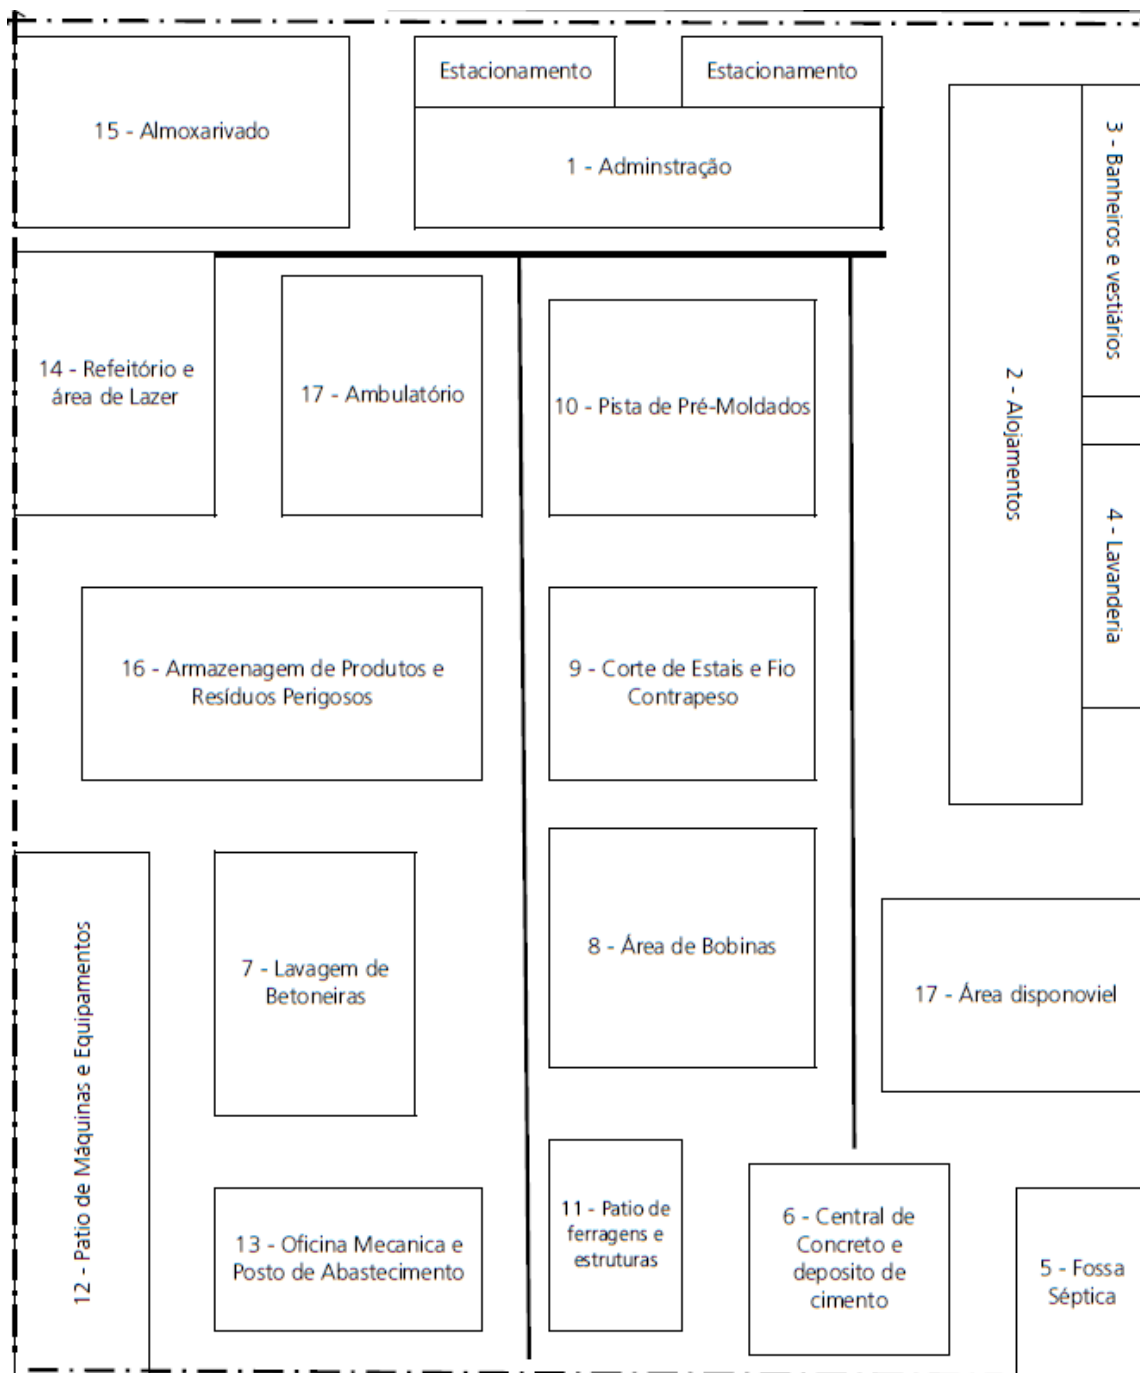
Layout típico do Canteiro de Obra da LT
